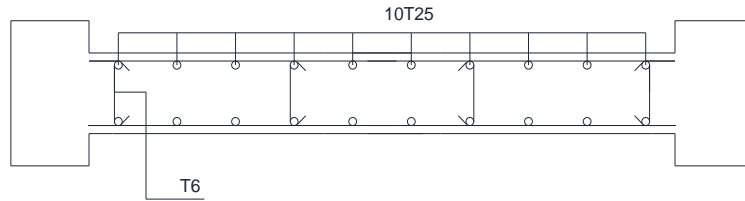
Schéma de ferrailage du voile (poutres noyées – bâtiment R+10)
